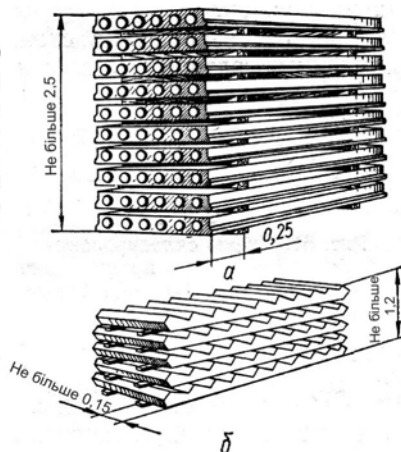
Схеми складування збірних залізобетонних конструкцій
